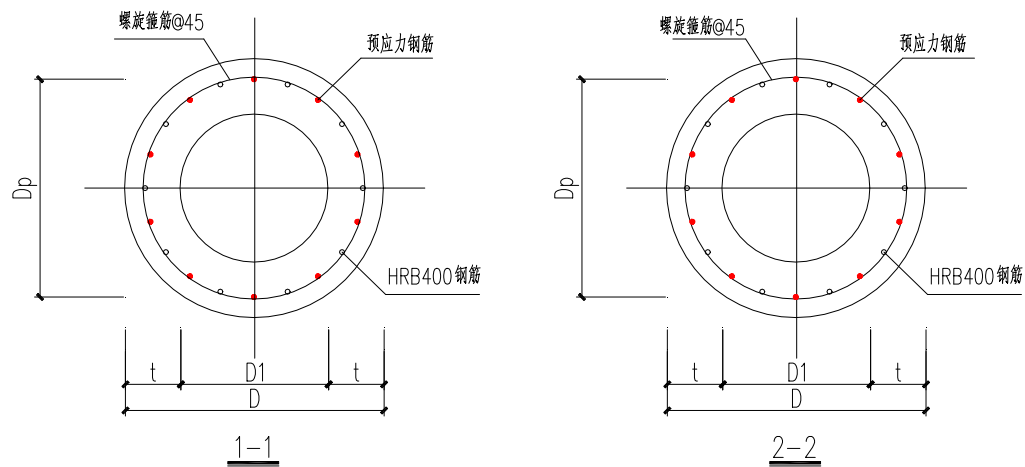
混合配筋预应力混凝土管桩截面配筋图
